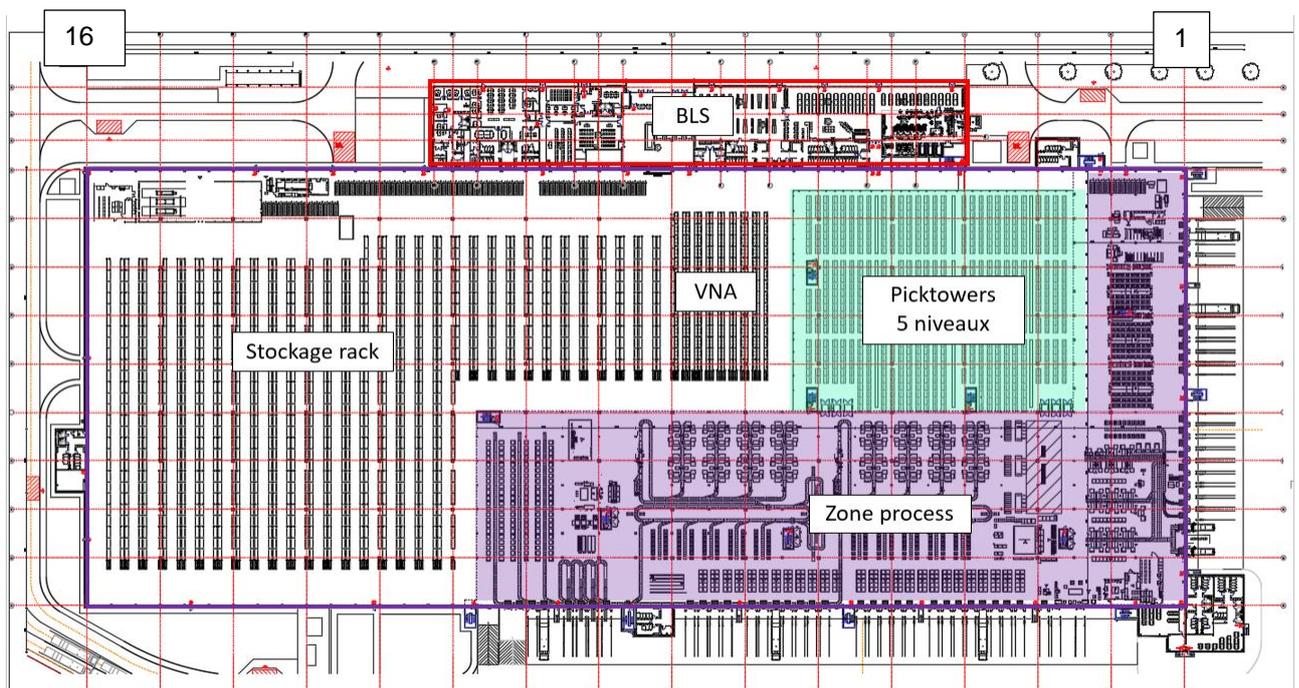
Plan du rez-de-chaussée (niveau P1)
